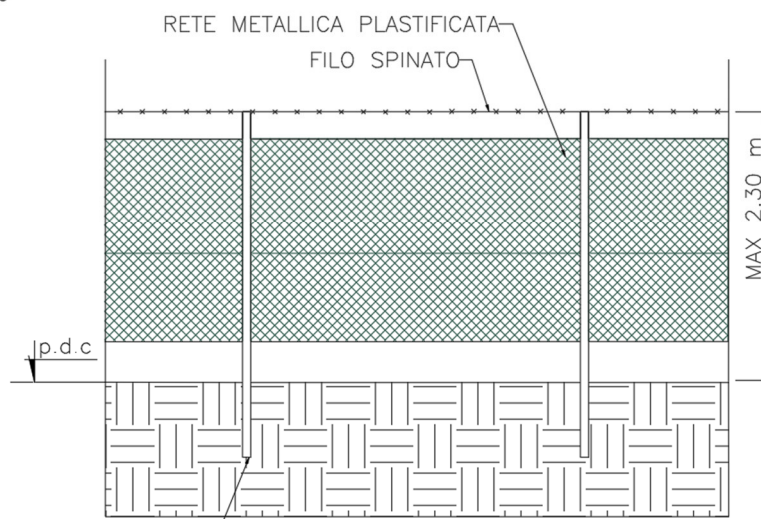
Tipico recinzione perimetrale area impianto di generazione
